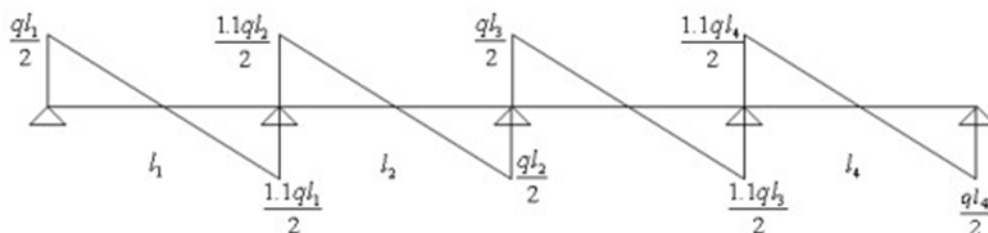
Effort tranchant d'une poutre à plus de 2 travées
